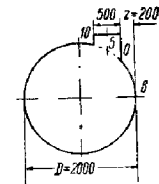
Вид горизонтальной оси 0-5-10 на резервуаре.
